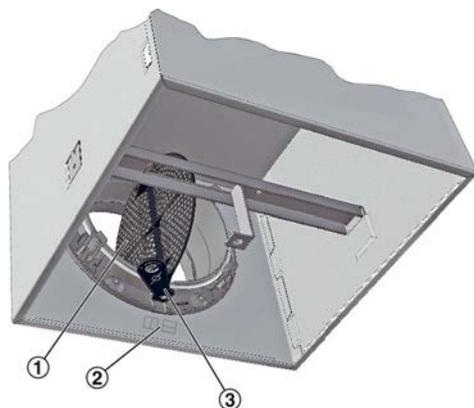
Pala della serranda completamente aperta (0°, solo con camera di raccordo)
